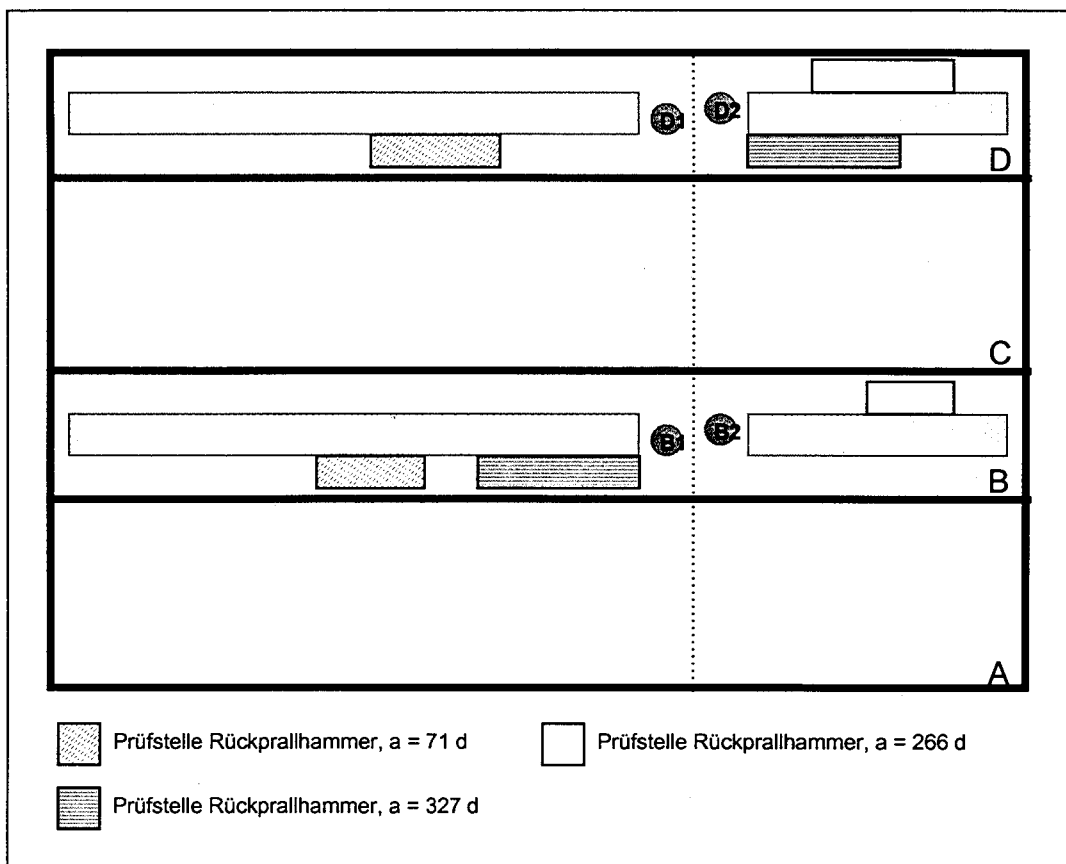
Lage der Prüfflächen am Betonkörper 17
